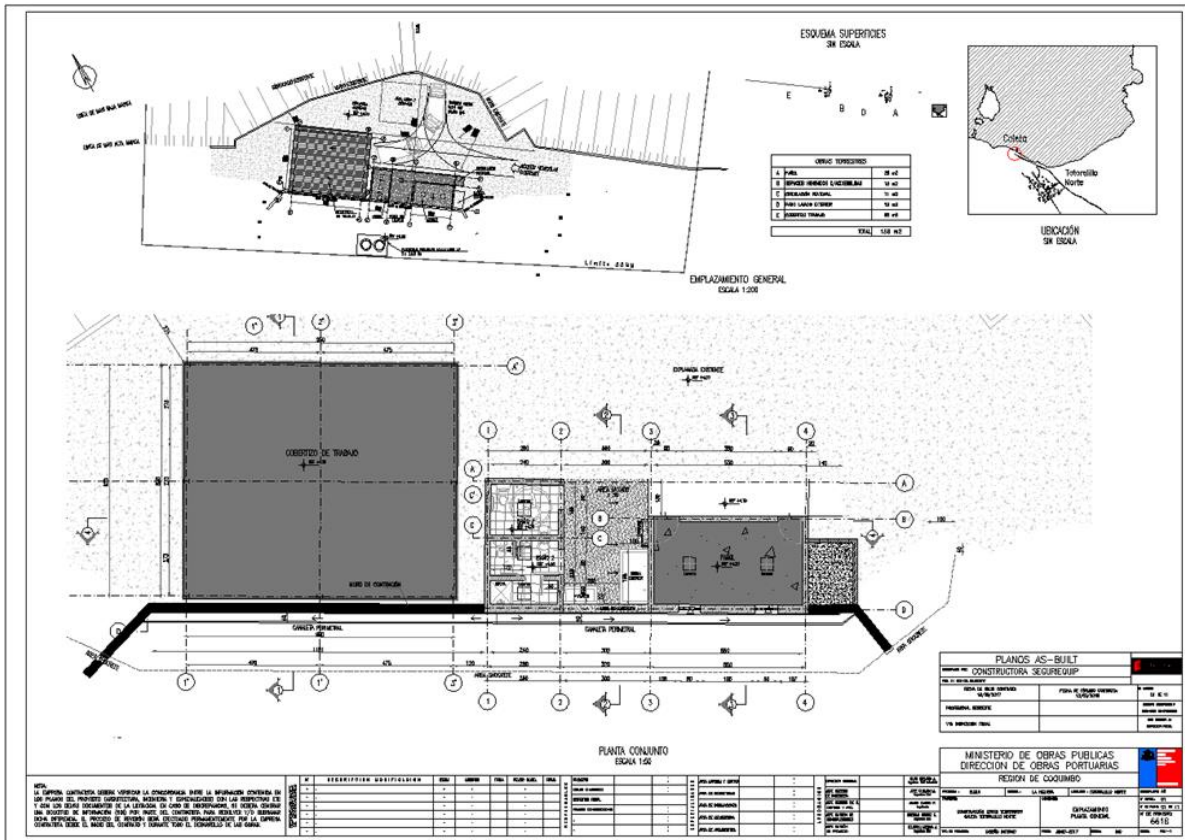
Planta General Caleta Totoralillo, Planos AS BUILT 2017.
